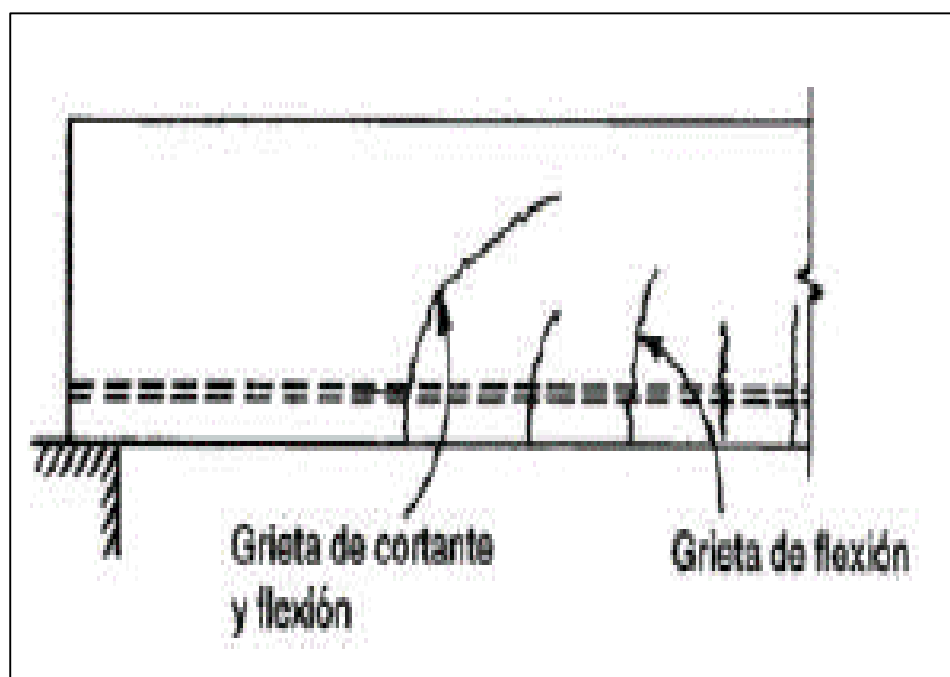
Corte y Flexión en Vigas de Concreto Reforzado.
